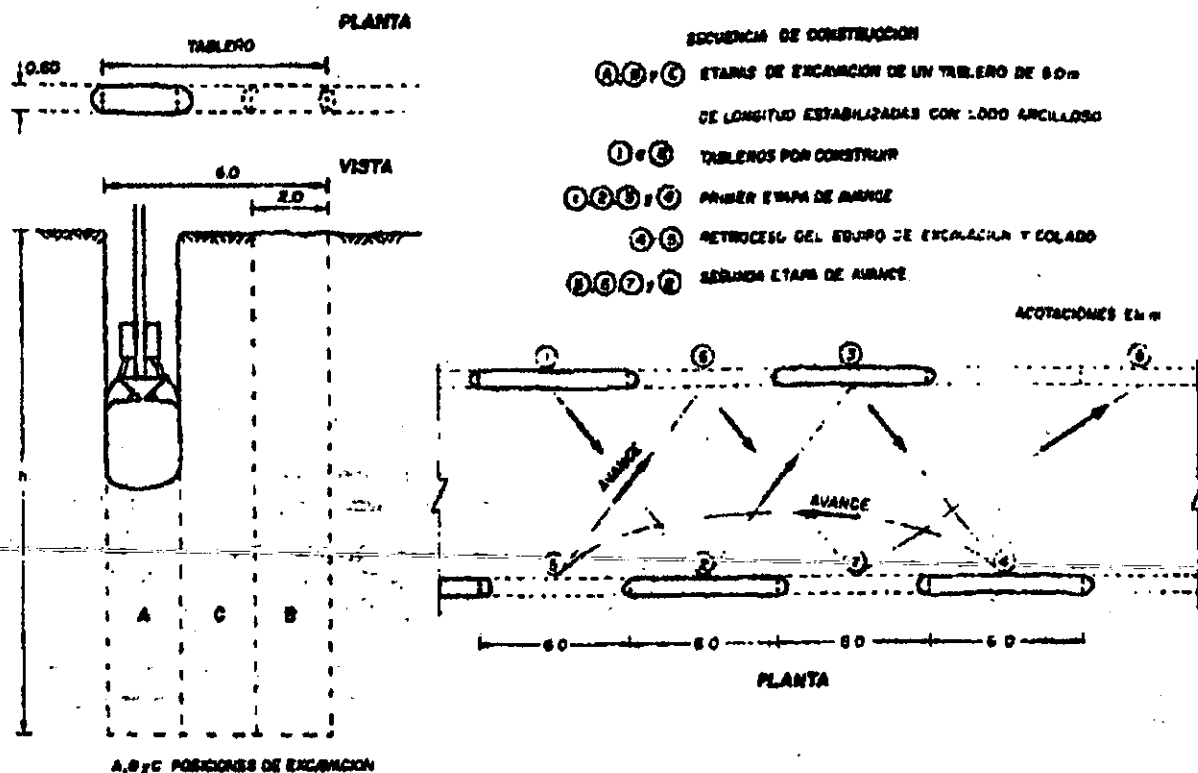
Procedimiento constructivo del muro Milán convencional.
